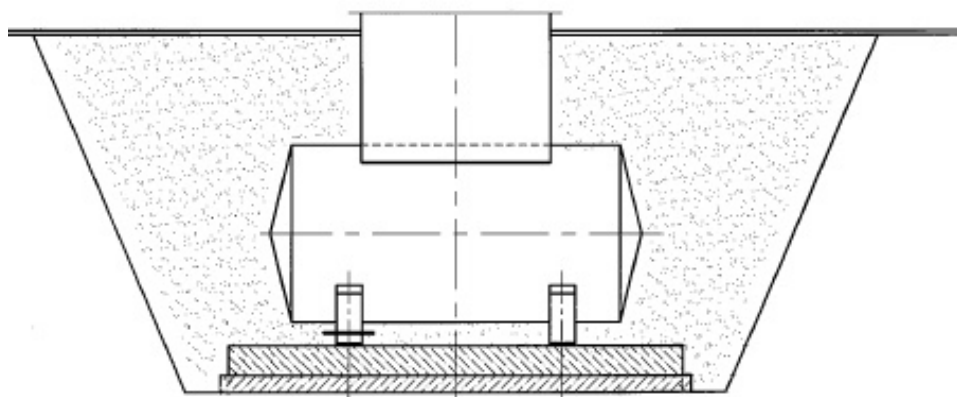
Общий вид эскиза резервуара РГС-15 зав.№ 6/10А
